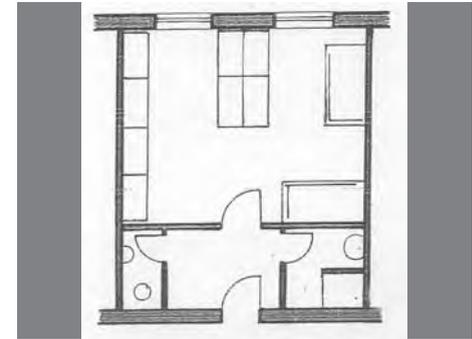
Grundrissdarstellung - Unterkunftsmodul C
